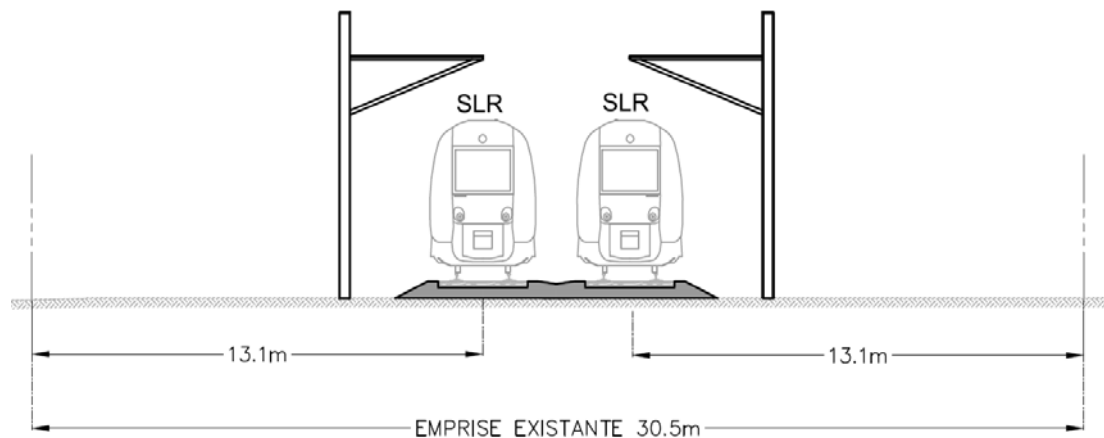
Coupe sur voie ballastée au niveau du sol
